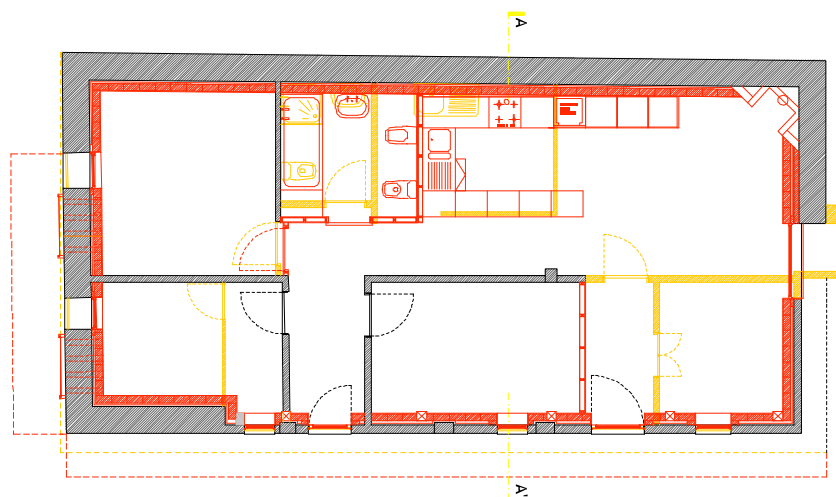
Planta do piso – elementos a manter, a retirar e a construir
